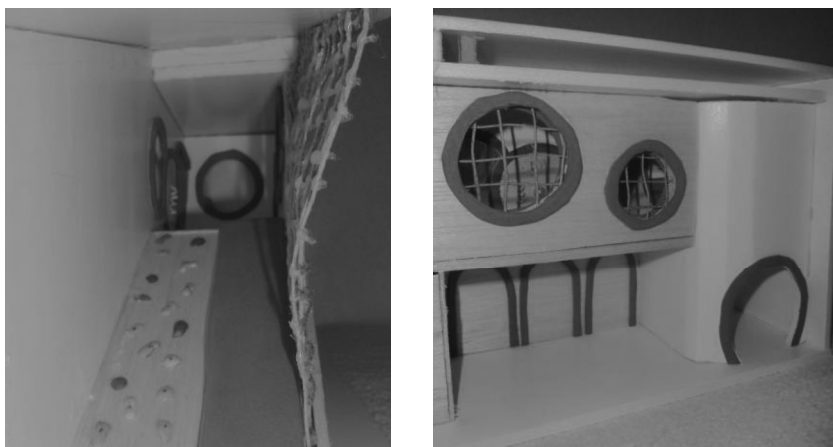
Pormenores da maquete á escala 1/20 (Fonte: O Autor)
